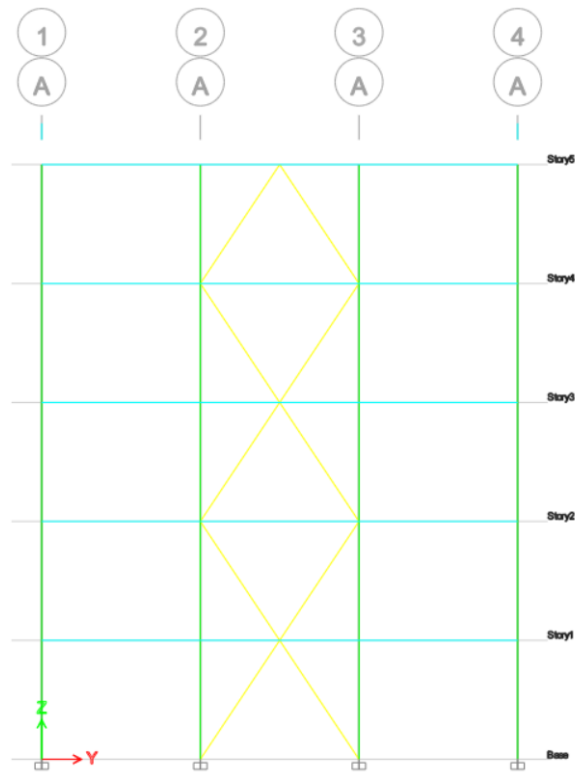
Vista en elevación del Pórtico Arriostrado Concéntricamente del eje A.
